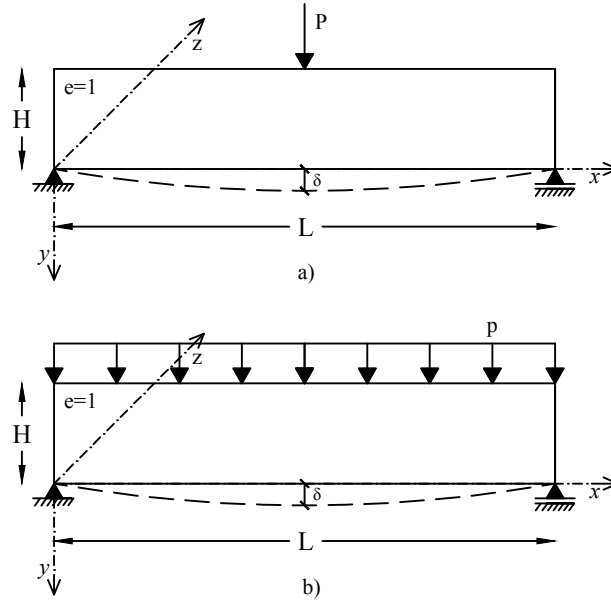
Modelo de cálculo de viga alta (idealização de uma estrutura): a) com carga pontual aplicada; b) com carga uniformemente aplicada.
